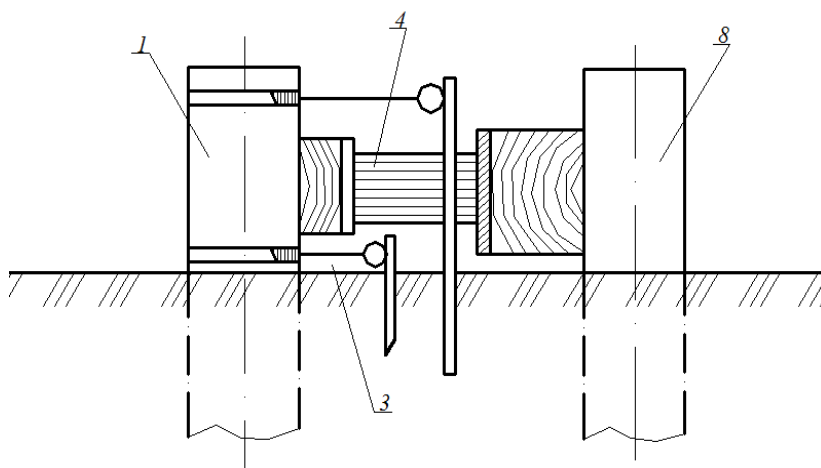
Схема установки для испытания грунтов статической выдергивающей нагрузкой
